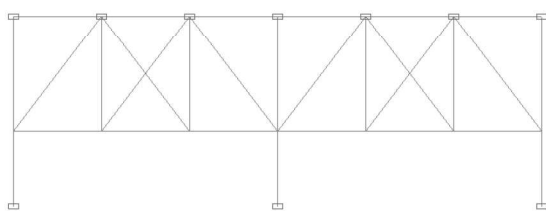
Расчетная схема нижнего пояса для расчета по методу № 5
